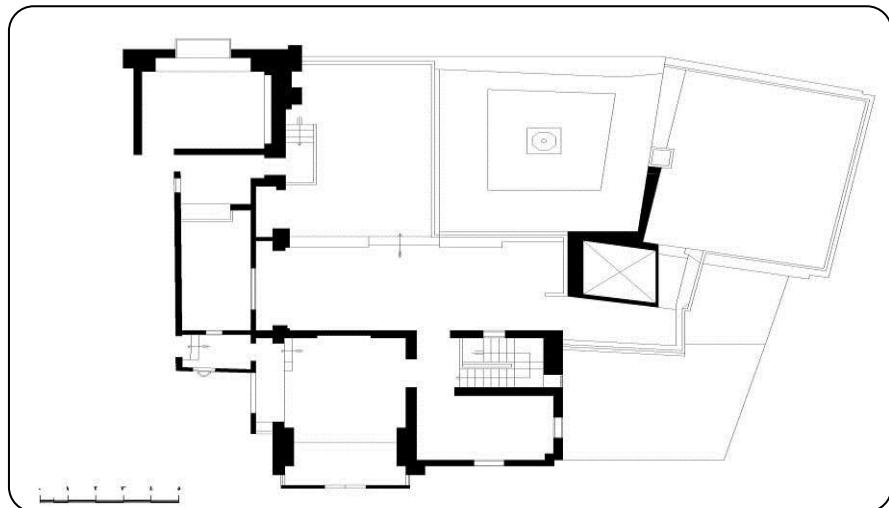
المسقط الأفقي للدور الأول للبيت العثماني موضع الدراسة (مندثر حالياً) (عمل الباحثان)
